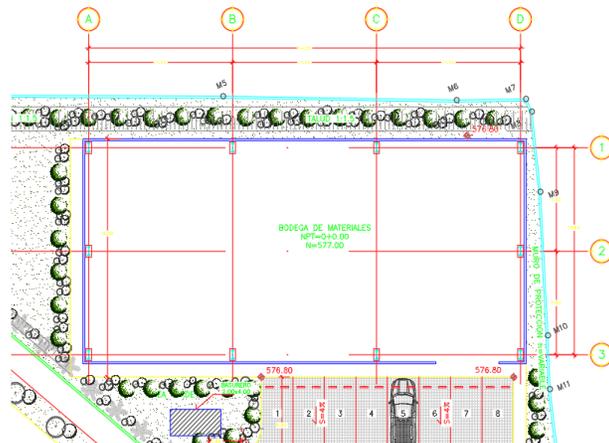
Planta Nave Secundaria. Nivel 1.
